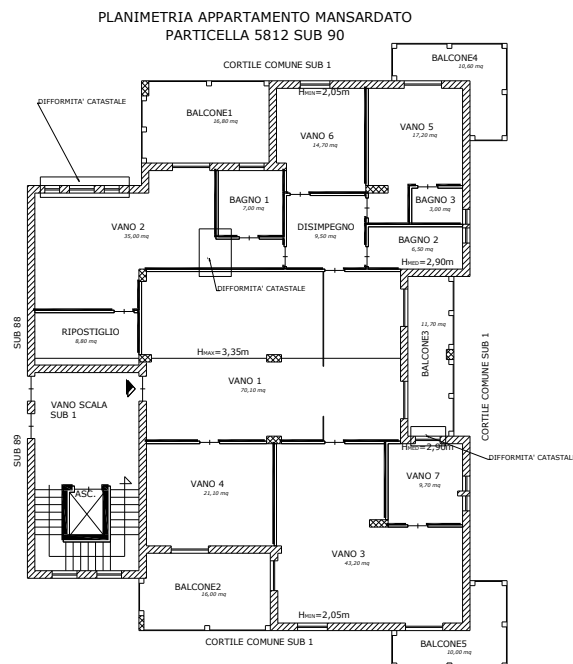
planimetria delle difformità catastali dell'appartamento mansardato al quinto piano
